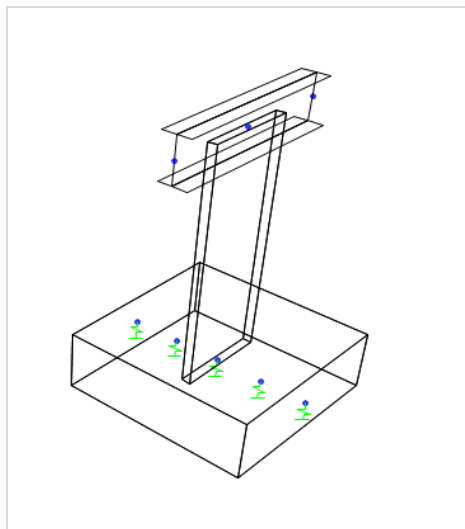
Sistema con viga de carga sobre el eje del espécimen.
